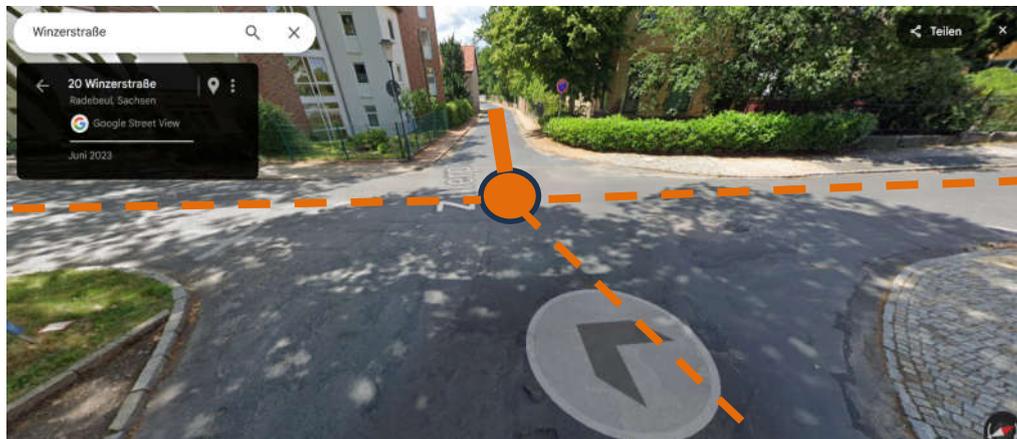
Baubeginn, Winzerstraße, Einmündung Zillerstraße, Schacht 7.7.3-12, Blickrichtung Kanalbau Winzerstraße
